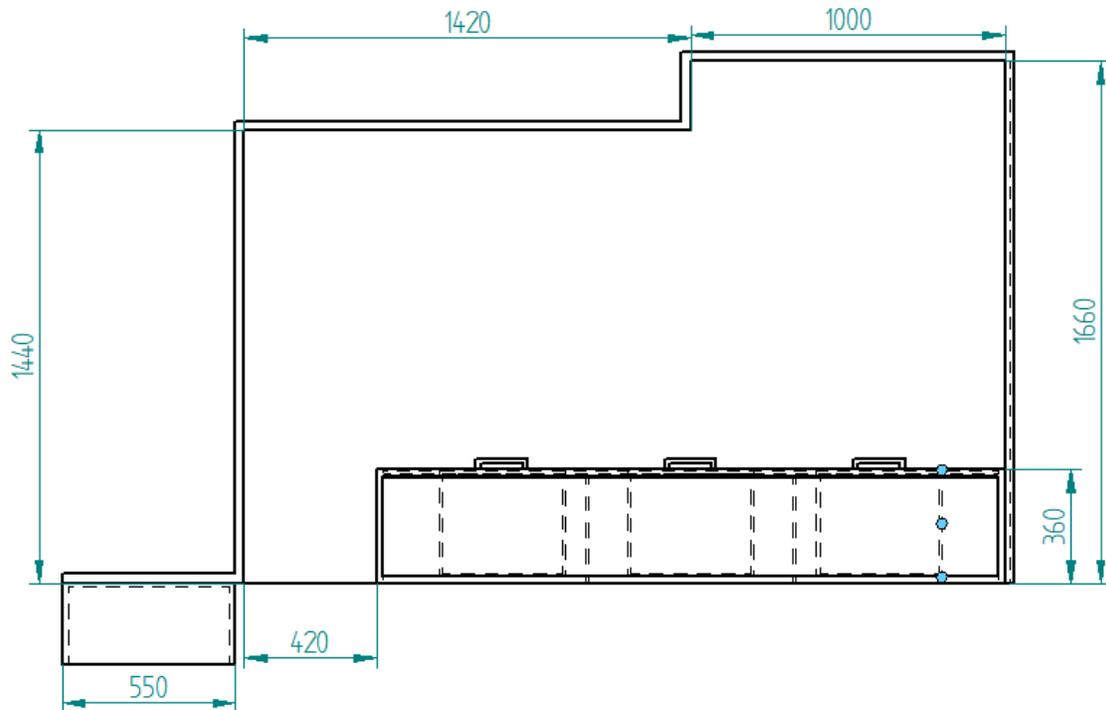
Vista de planta de la sucursal (cotas en milímetros)
